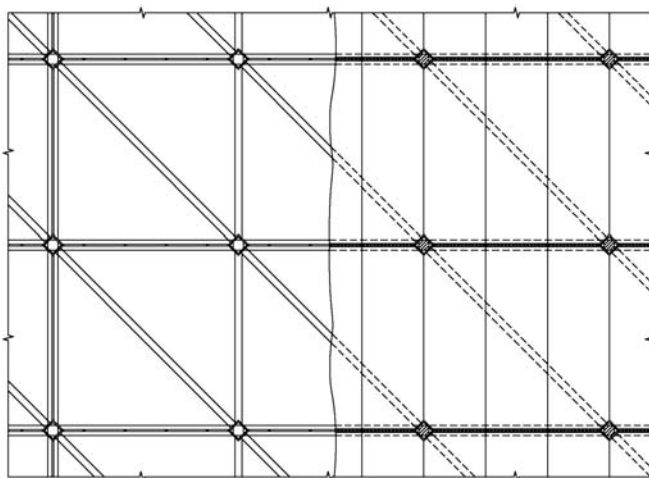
Фрагмент плана металлической цилиндрической сетчатой оболочки со сборными граневыми фермами
